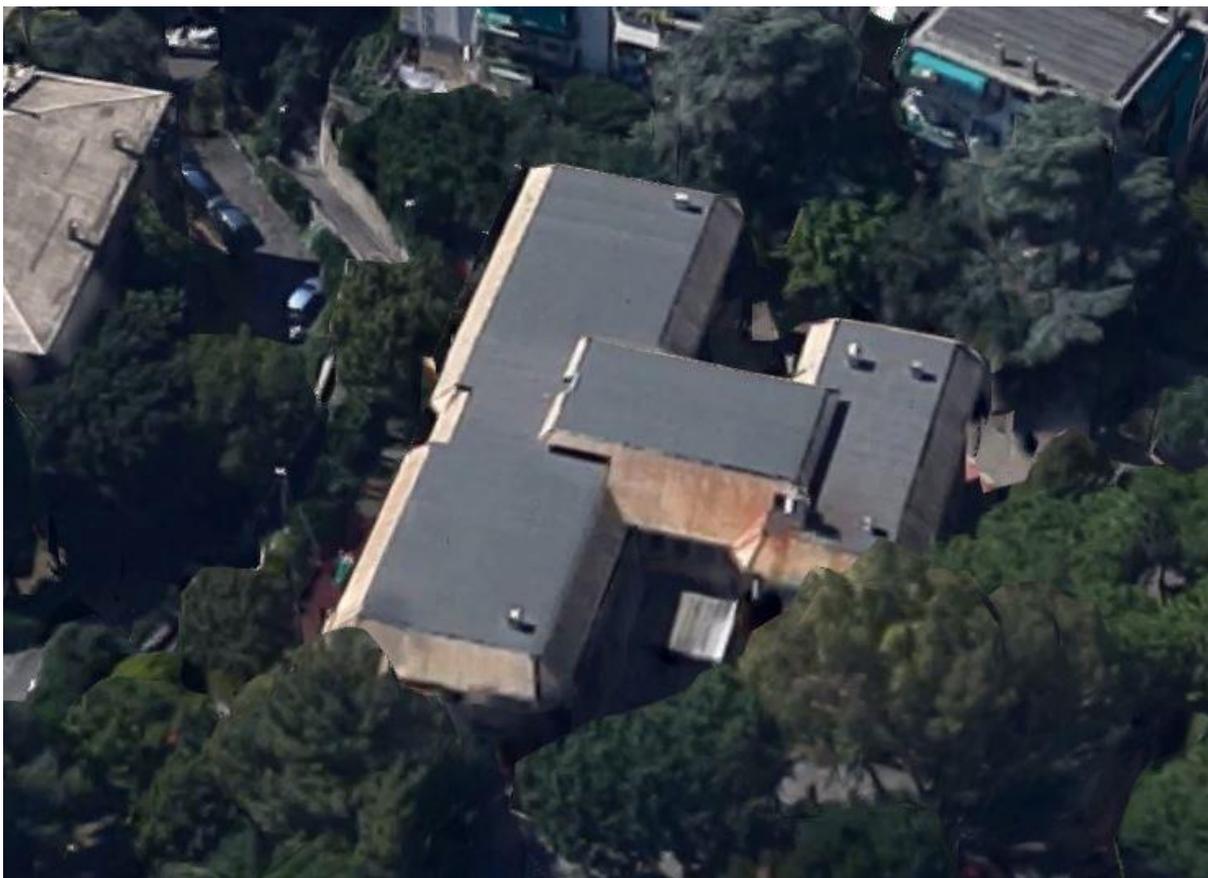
Foto Aerea dell'edificio oggetto dell'intervento
